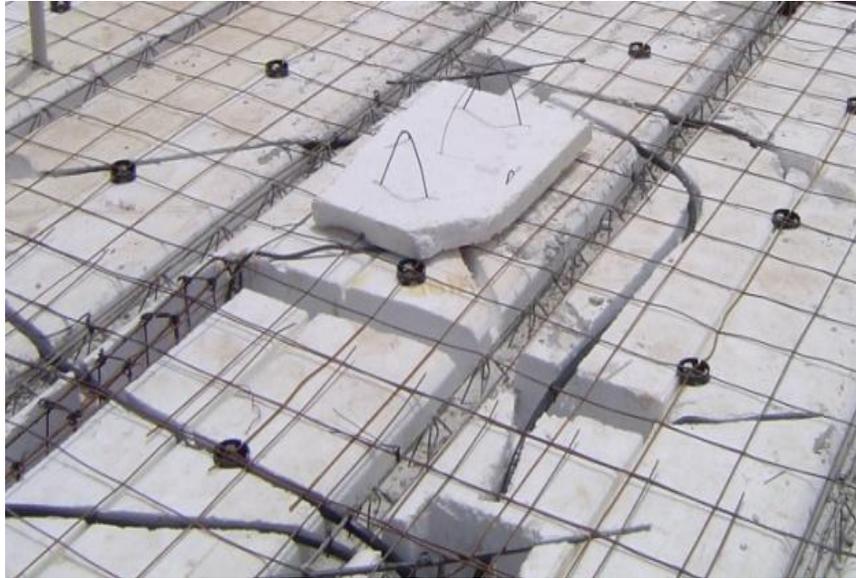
Detalle de una losa con aislante térmico con malla e instalaciones.
